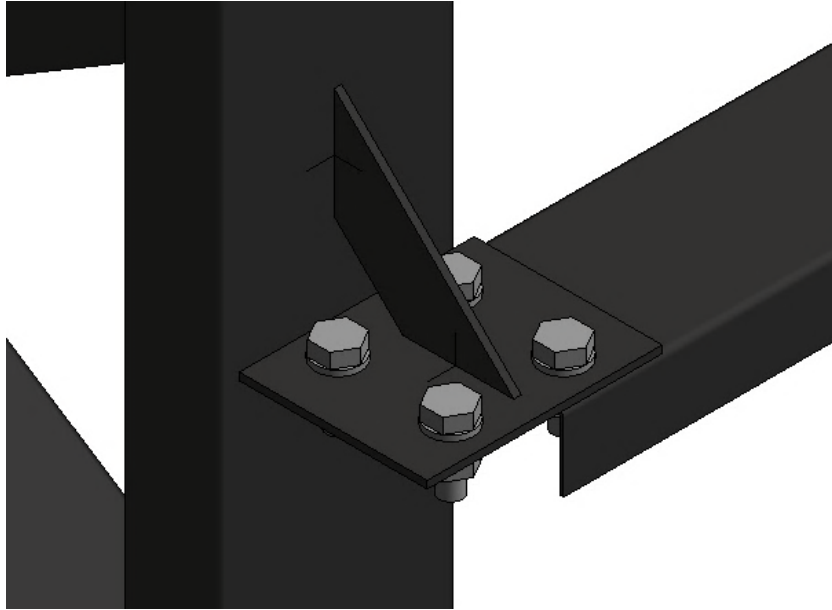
Vista tridimensional da ligação pilar | madre de fachada no Revit 2020
